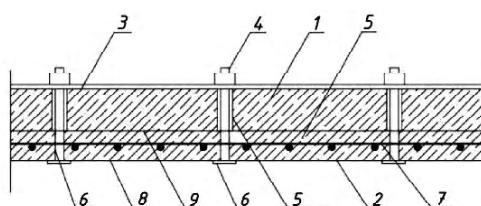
Устройство железобетонного нарастивания снизу плиты при недостаточном сцеплении нового бетона со старым: 1 – усиваемая железобетонная плита; 2 – железобетонное нарастивание; 3 – стальная полоса, прикрепленная к плите анкерными болтами; 4 – анкерные болты, установленные в просверленные в плите отверстия; 5 – отверстия, просверленные в плите; 6 – шайбы; 7 – арматурная сетка, приваренная к стальным полосам; 8 – бетон нарастивания, наносимый методом торкретирования; 9 – поверхность усиваемой плиты, подготовленная к бетонированию).
